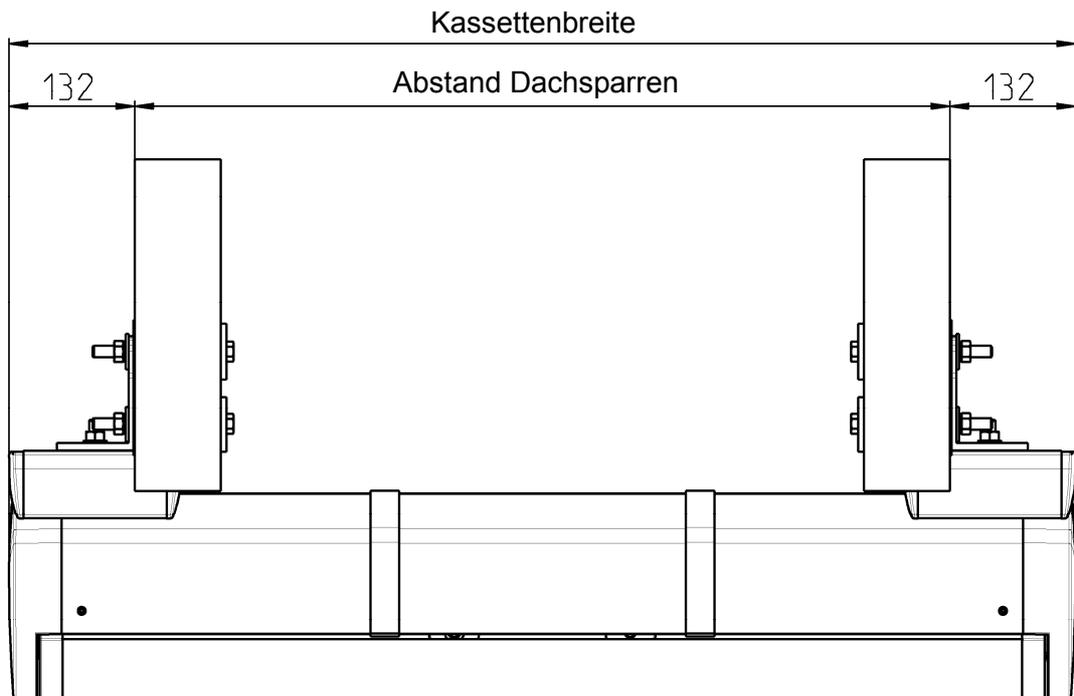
Standard Dachsparrenbefestigung mit Dachsparrenhalter ohne Montageplatte
